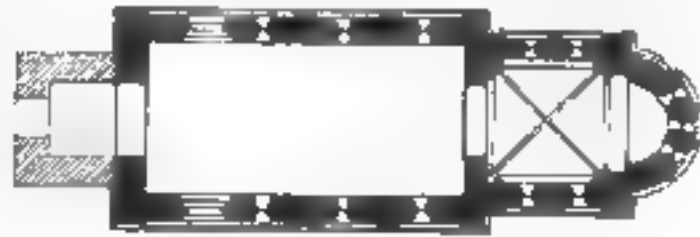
Grundriss der Kirche zu Roager.
